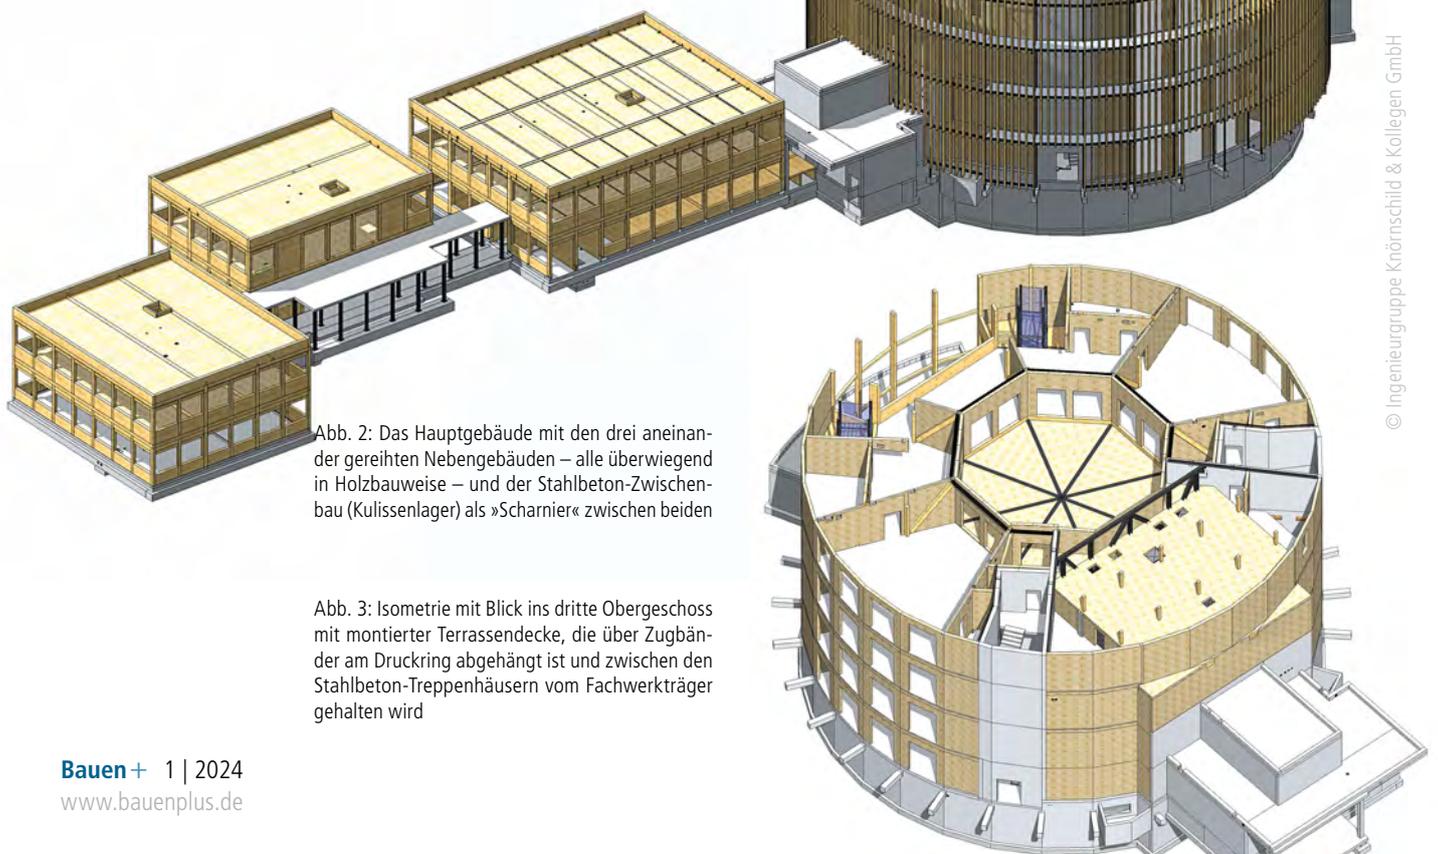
Das Hauptgebäude mit den drei aneinander gereihten Nebengebäuden – alle überwiegend in Holzbauweise – und der Stahlbeton-Zwischenbau (Kulissenlager) als »Scharnier« zwischen beiden
